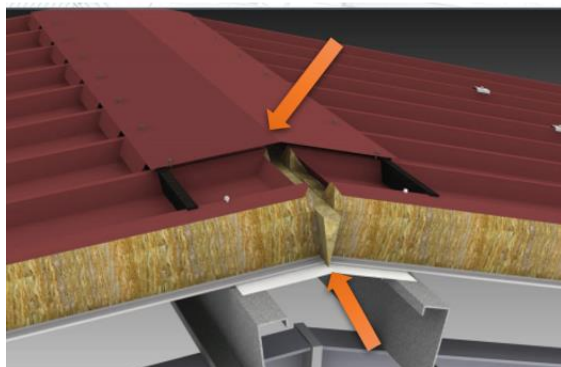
Pormenor construtivo da FTB (cumeeiras)
